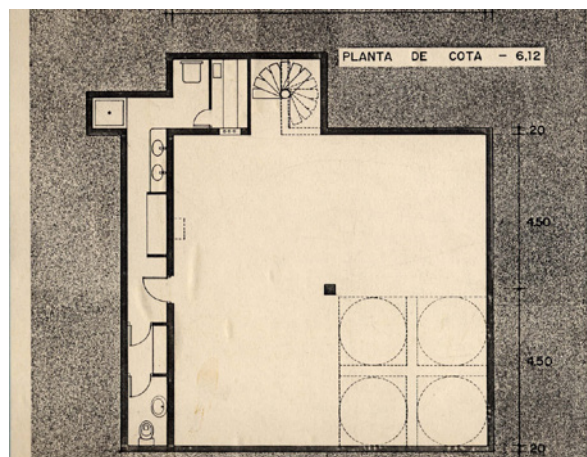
Planta del estudio. Nivel -2 (cota -6,12). Original del proyecto
